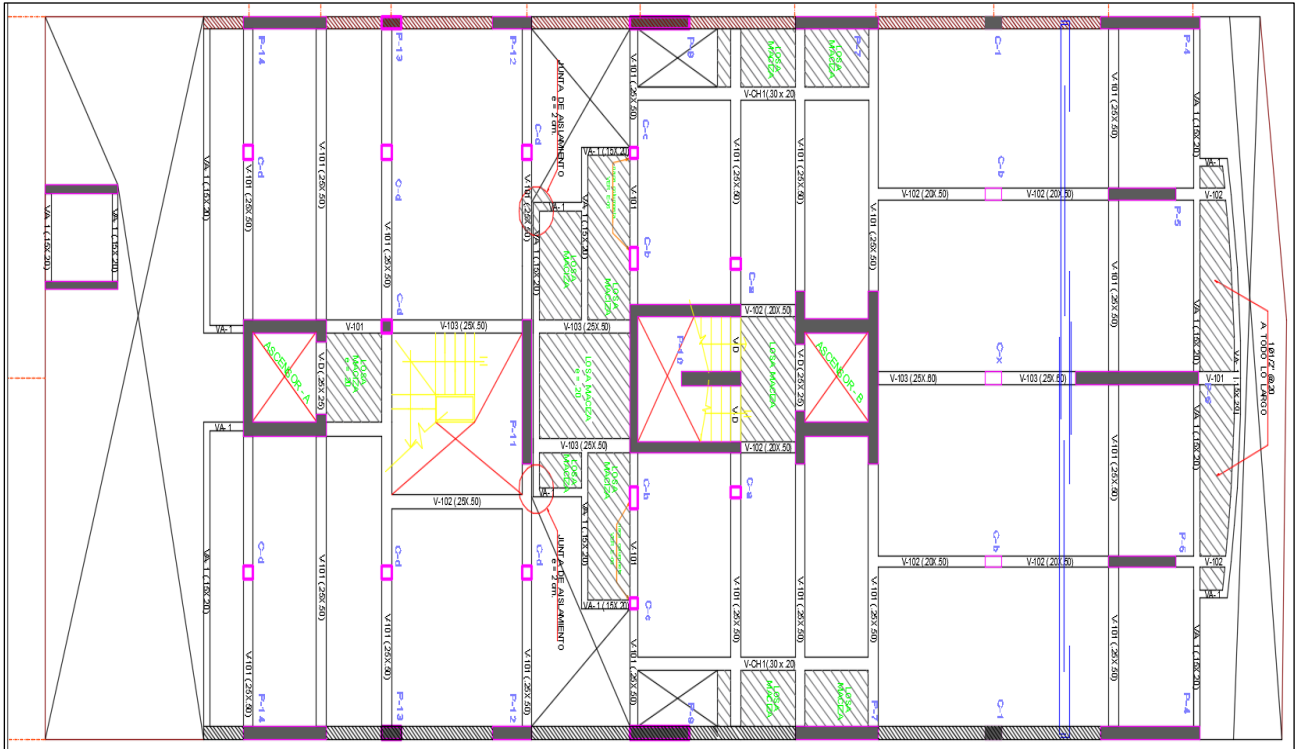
Distribución en planta de los elementos estructurales (2do al 15vo Piso)
